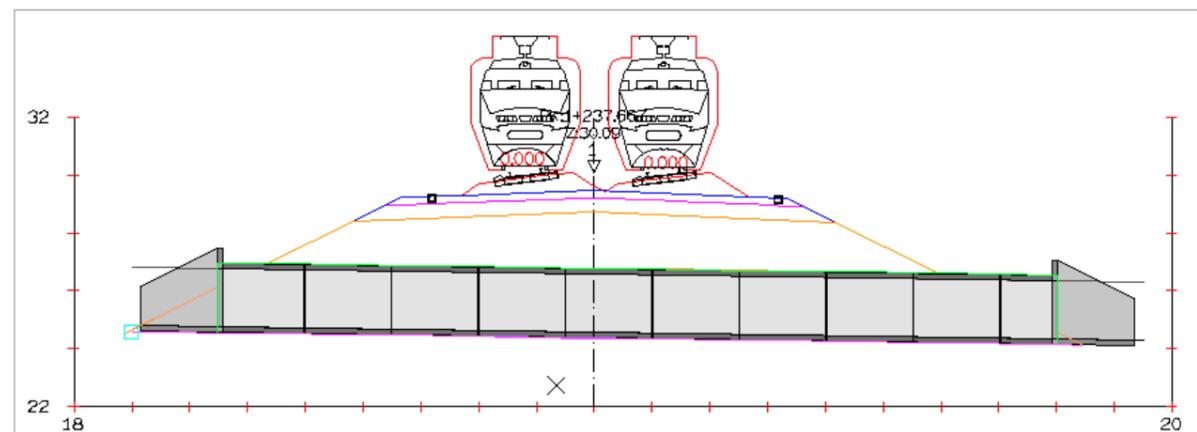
ODT del eje Mar-Gornazo en alzado. Fuente: Istram
